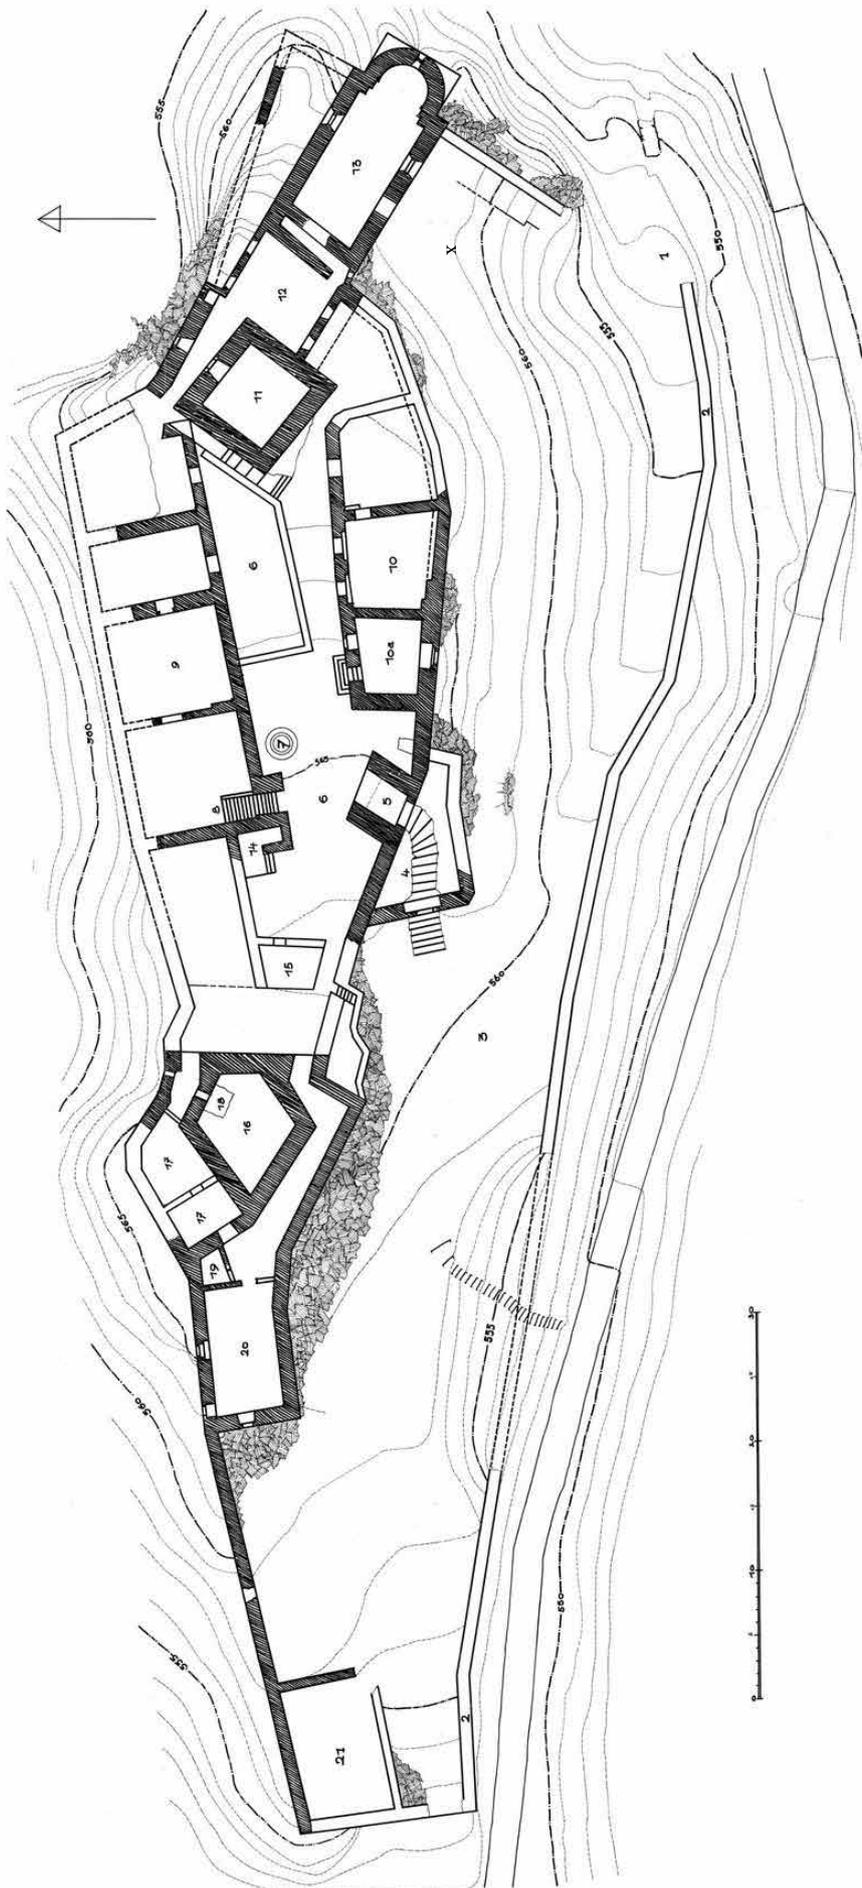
Grundriss Burg Gösting mit Bezeichnung der Bauteile; M 1:1000
